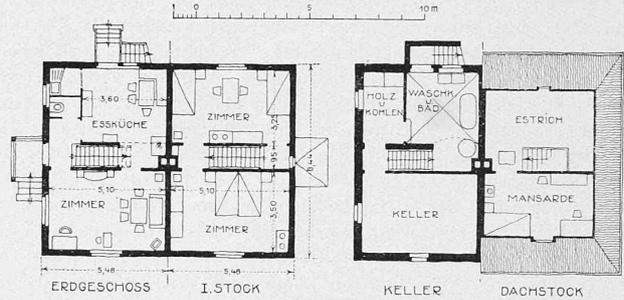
Grundrisse der ausgeführten Häuser. — Masstab 1 : 300. — Abb. 4. Grundrisse laut erstem Vorschlag.
